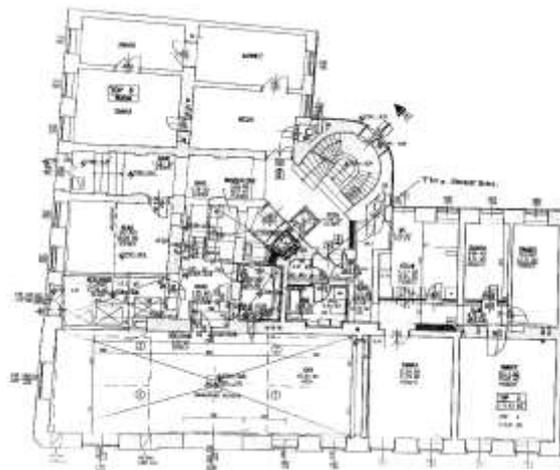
Grundriss Schiffamtsgasse 7
